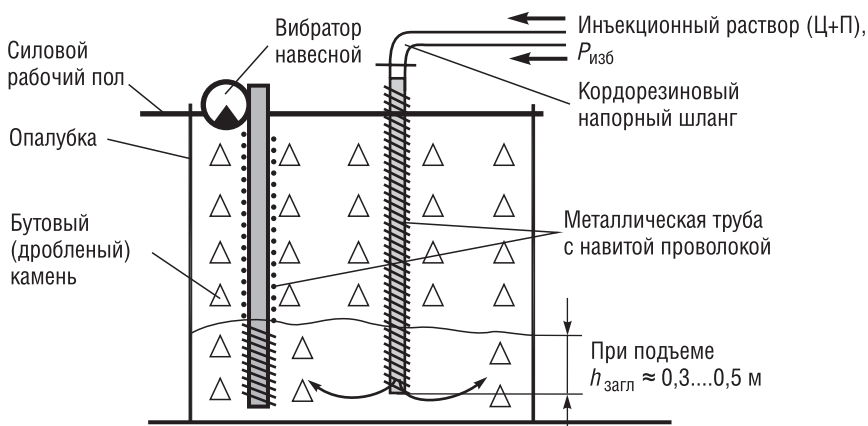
Схема способа раздельного бетонирования профессора И.Н. Ахвердова
